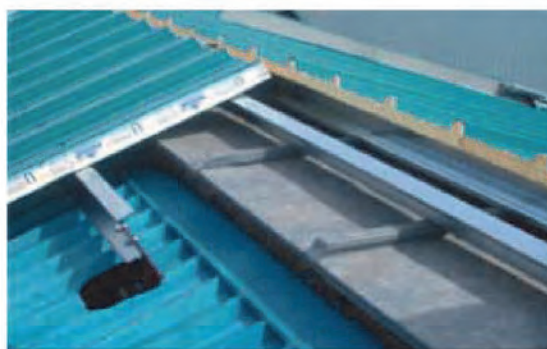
Установка новой фасадной системы на старый фасад промышленного здания с применением системы SolarWall™ (г. Дарем, Великобритания)
